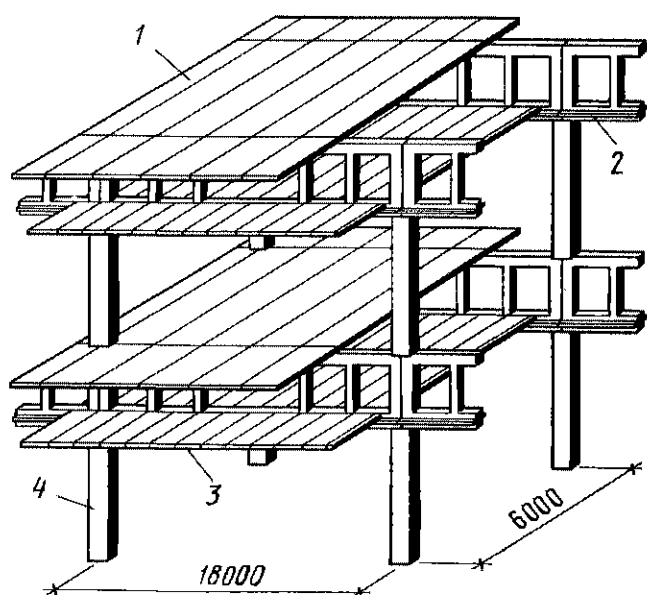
Многоэтажное сборное здание с межферменными этажами
